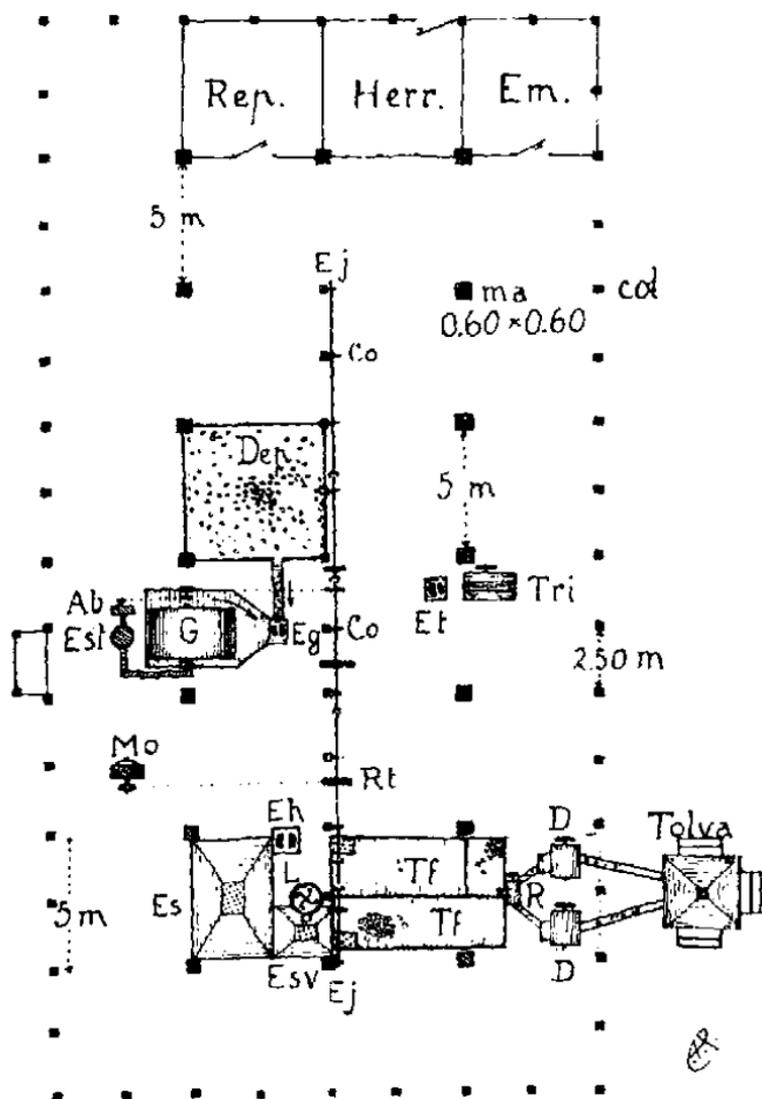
Tercer tipo de instalación: plano. Ab, abanico; Co, cojinetes; Col, columnas; D, descerezadora; Dep, depósito de café de trilla; Eg, elevador de la guardiola; Eh, elevador de húmedo; Ej-Ej, eje; Est, estufa y junto a ella el depósito de cisco; Es, escurridor; Esv, escurridor de vano; Et, elevador de trillado; G, guardiola u Okrassa; Mo, motor; R, repasadora; Tf, tanques de fermentación.
